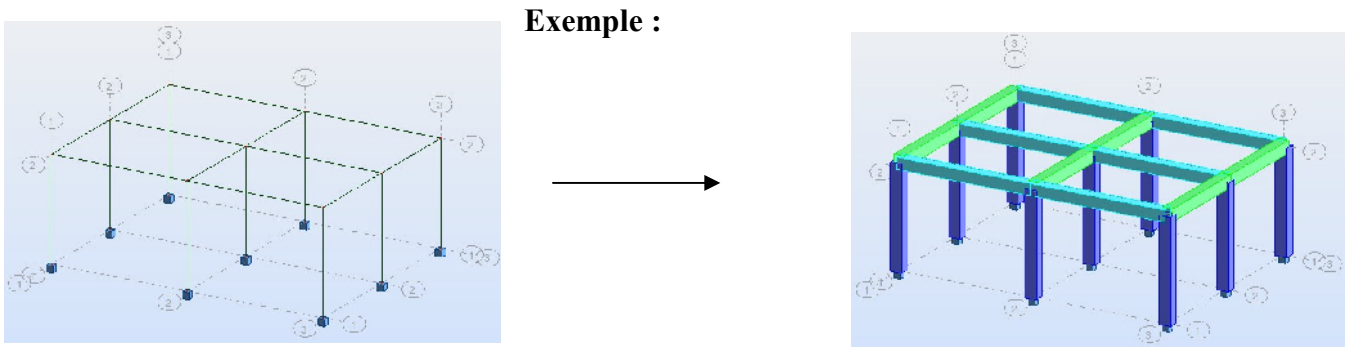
Modélisation des poteaux et des poutres.
